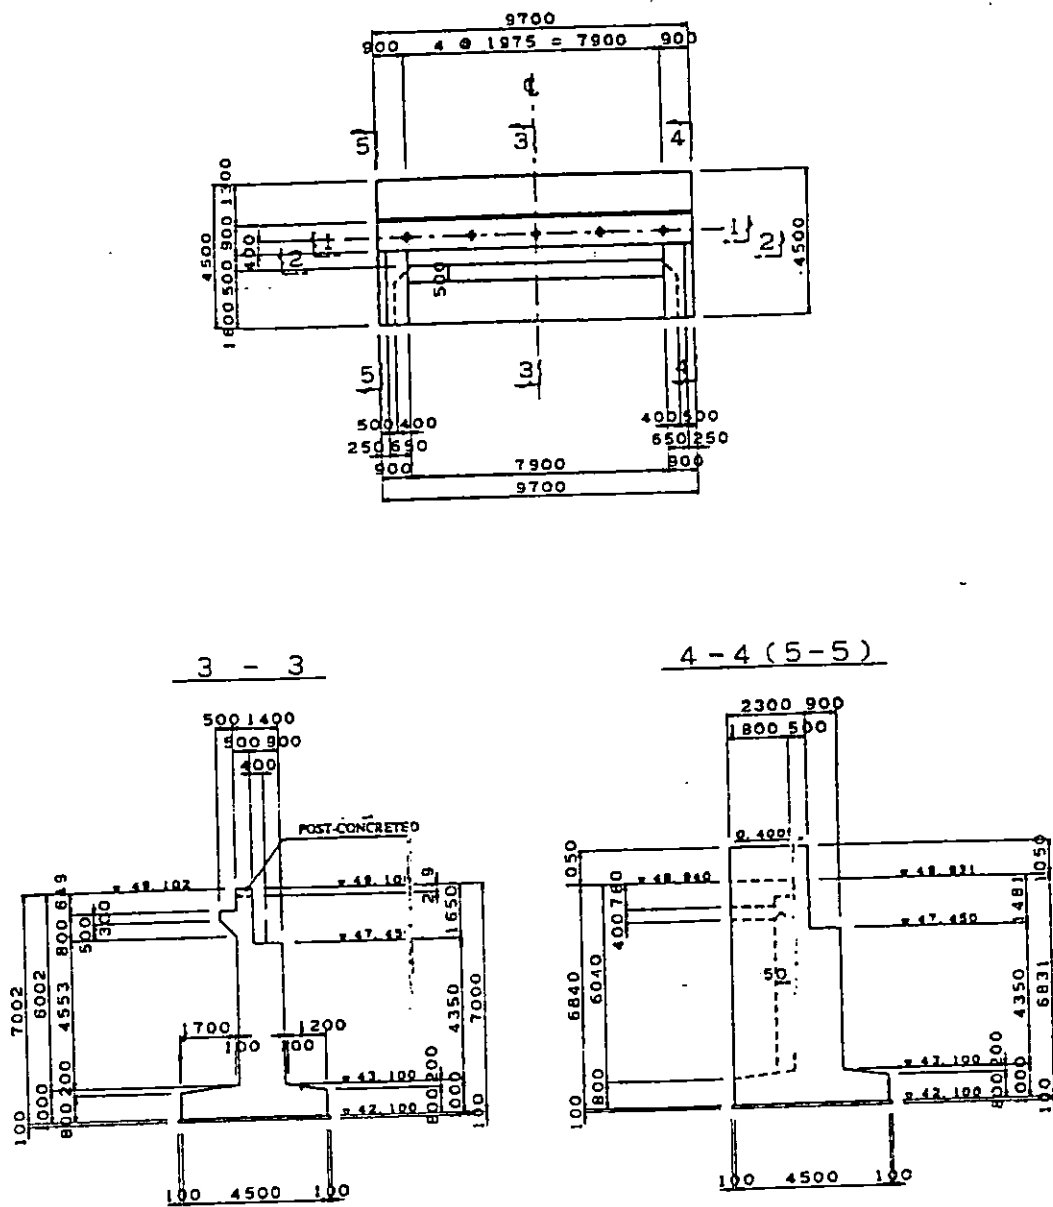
DETALLES DEL ESTRIBO A1.
